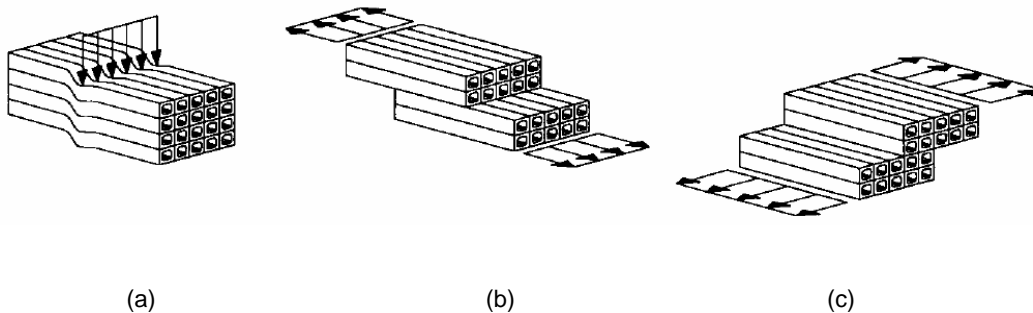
Tensões de corte que podem ocorrer na madeira: a) corte, b) deslizamento longitudinal, c) deslizamento transversal, (Branco, 2006)
